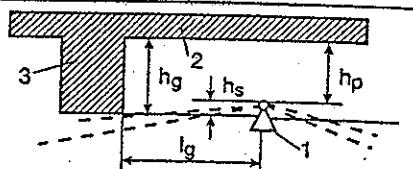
Distanțele de amplasare ale sprinklerelor față de planșee și grinzi:
